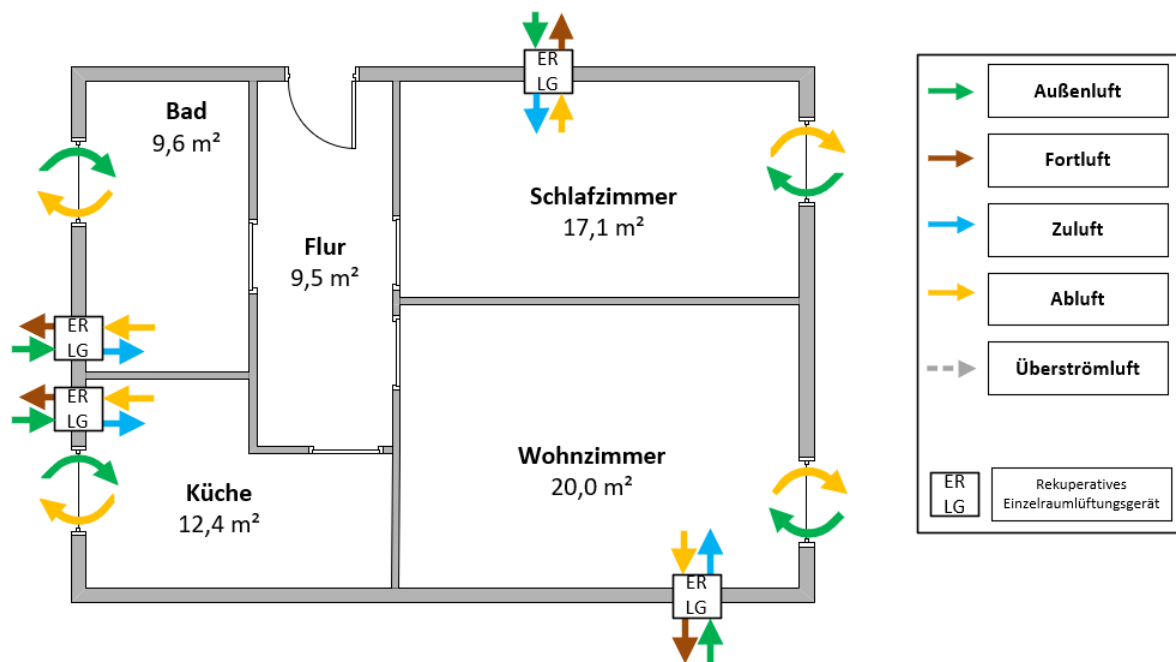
Grundriss Zwei-Zimmer-Wohnung, schematische Darstellung rekuperative Einzelraumlüftungsgeräte in allen Räumen, ergänzt durch bedarfsgeführte Fensterlüftung
